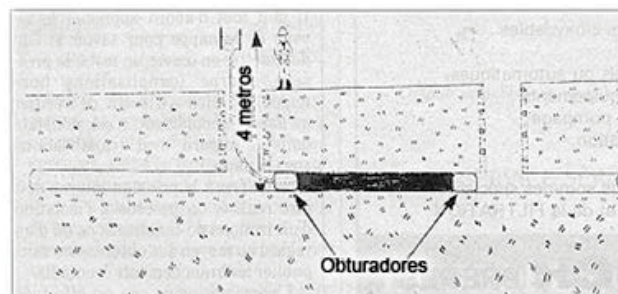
PRUEBA BAJO PRESIÓN DE AGUA INTERNA de un tramo de tubería
